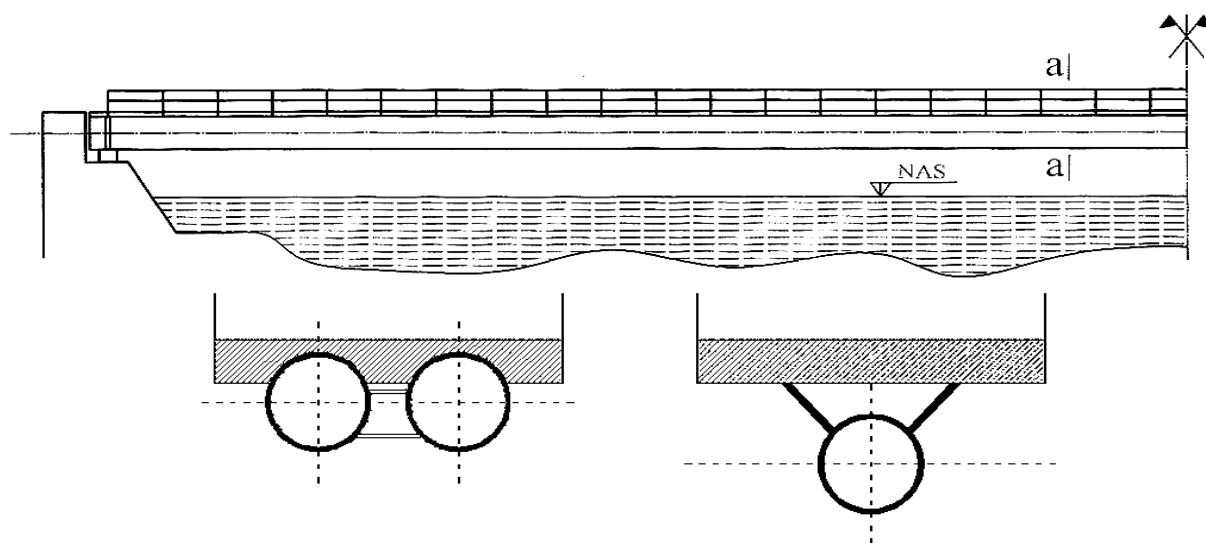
3 – Soluții de alcăuire a dalelor – monolit sau prefabricat [23]
